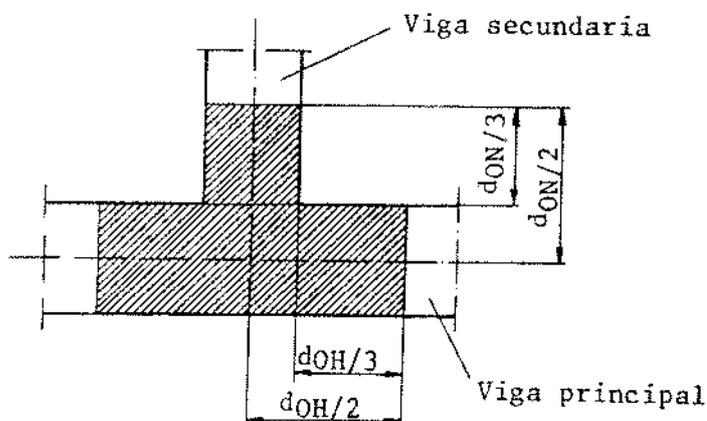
Zona de entrecruzamiento para el apoyo de vigas secundarias.
